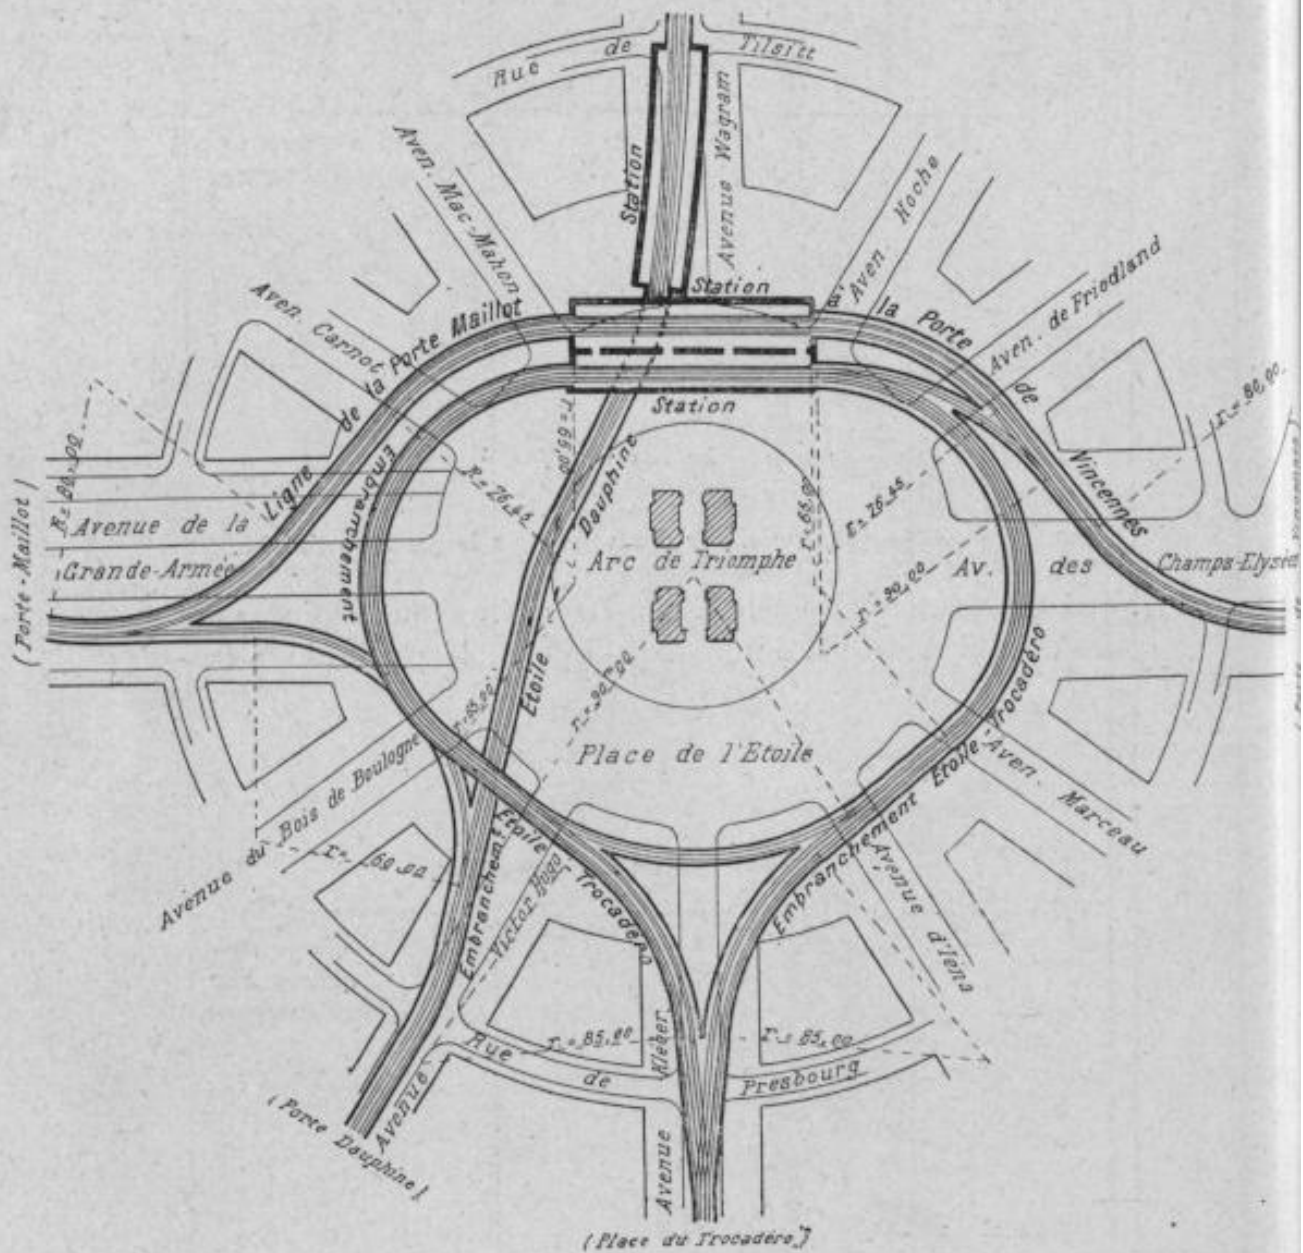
Plan des voies et des stations sous la place de l'Étoile.
